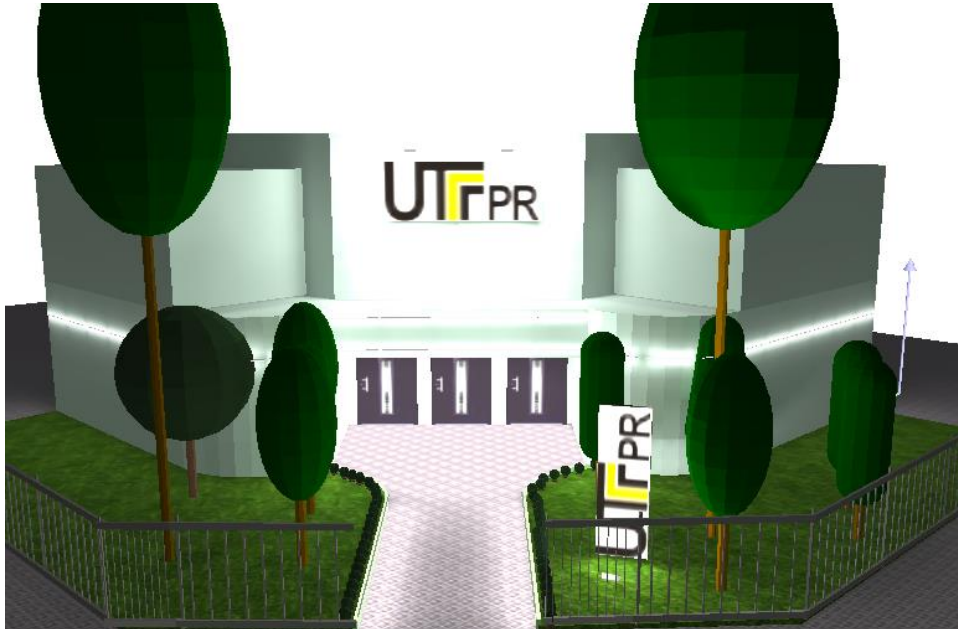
Visualização em 3D da fachada do bloco J/bloco N.
